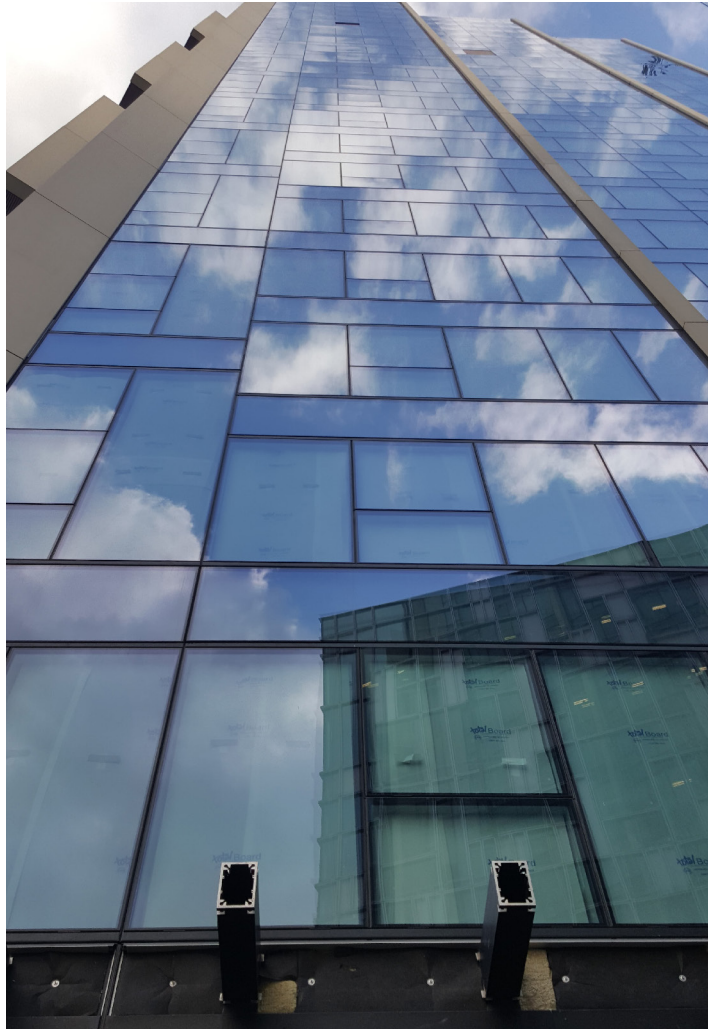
Building foto's (Scheldebouw, 2019)
